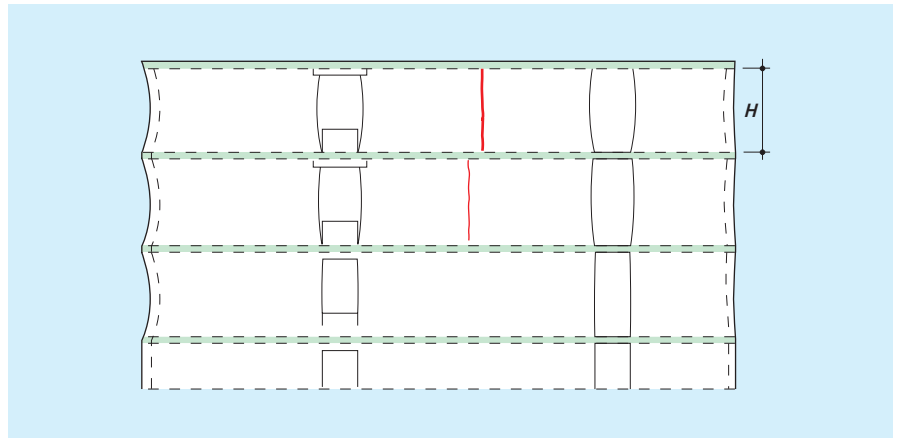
Verformungsfall H1: Verkürzung der Wände gegenüber den Geschossdecken
